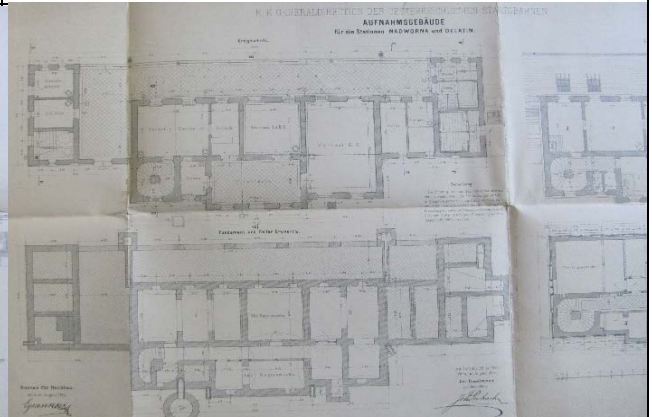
Фрагмент креслення планів будівель вокзалів станцій Надвірна і Делятин [23].
